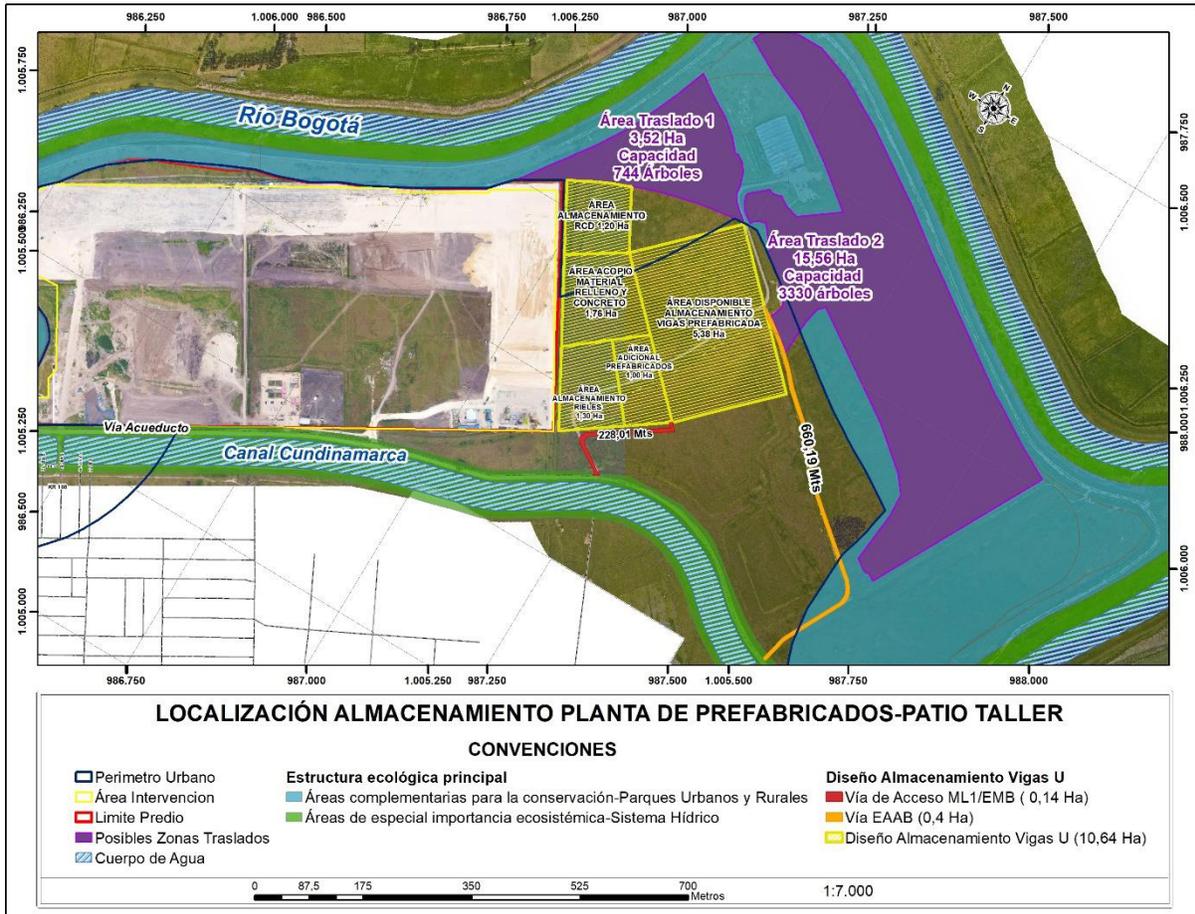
Distribución de las áreas en la Planta de Prefabricados
